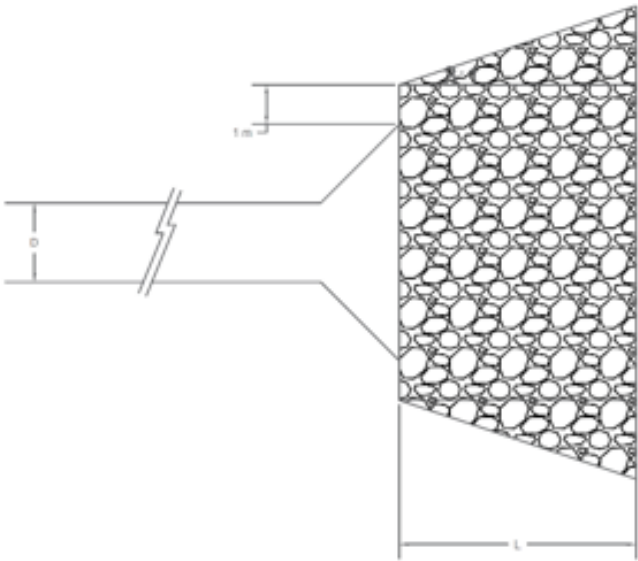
Esquema en planta del enrocado de protección para alcantarillas.
